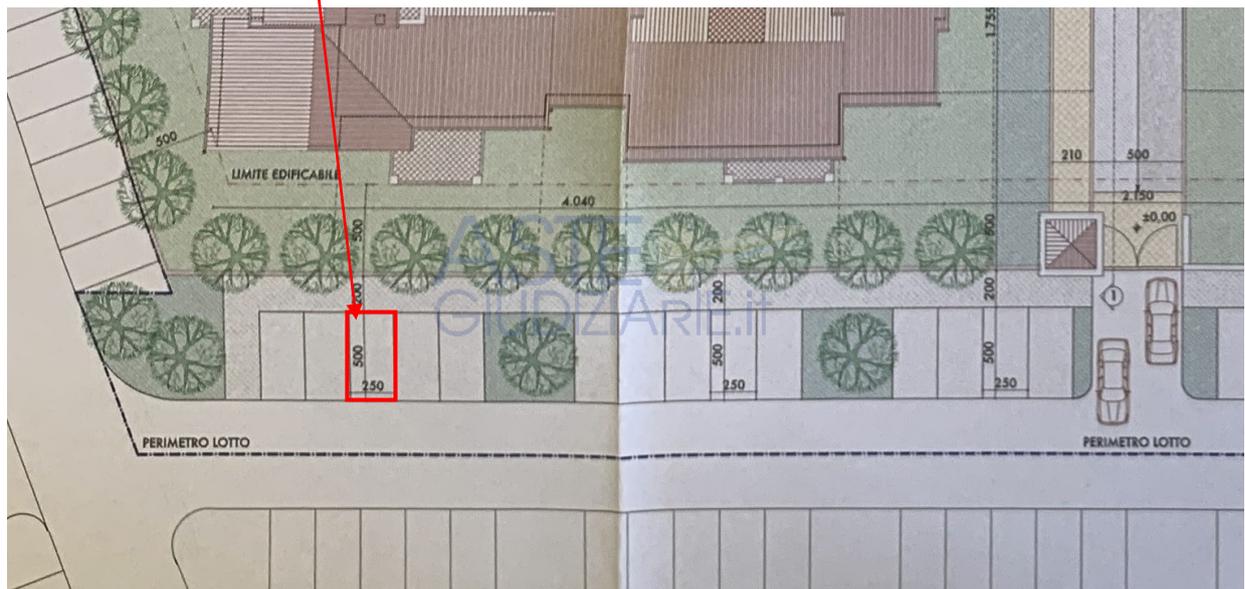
Estratto planimetria generale D.I.A. Prot. 36738 del 18.12.2007 con indicazione dell'u.i. in oggetto
